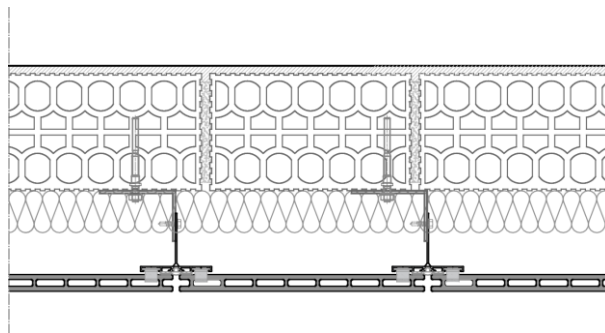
Sección horizontal. Faveton® SAH Acqua 20-V.
